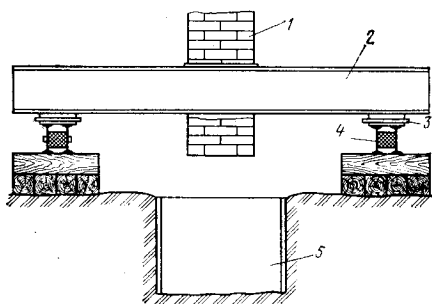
Передача нагрузки от зданий на временные опоры:
